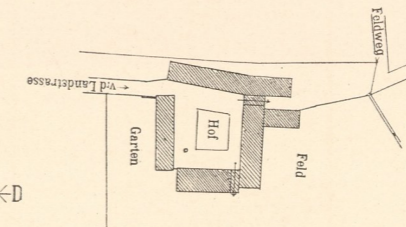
Hof in Wonsbeck. Lageplan. 1:3000.
